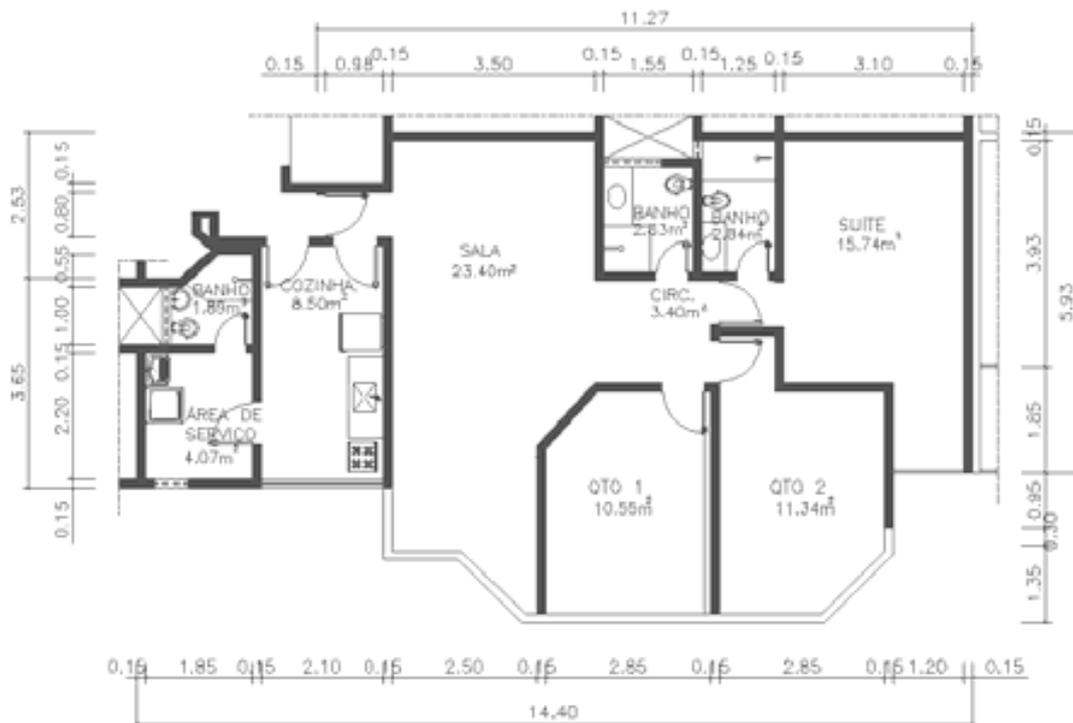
SQSW 304 – BLOCO C – Planta modificada
